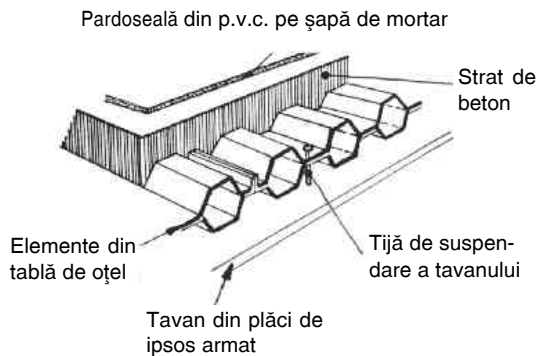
Planșee cu grinzi metalice din profile laminate și cu grinzi cu zăbrele mixte. Elemente de umplură din beton armat prefabricat și monolit. Planșee din profile cu pereți subțiri.
